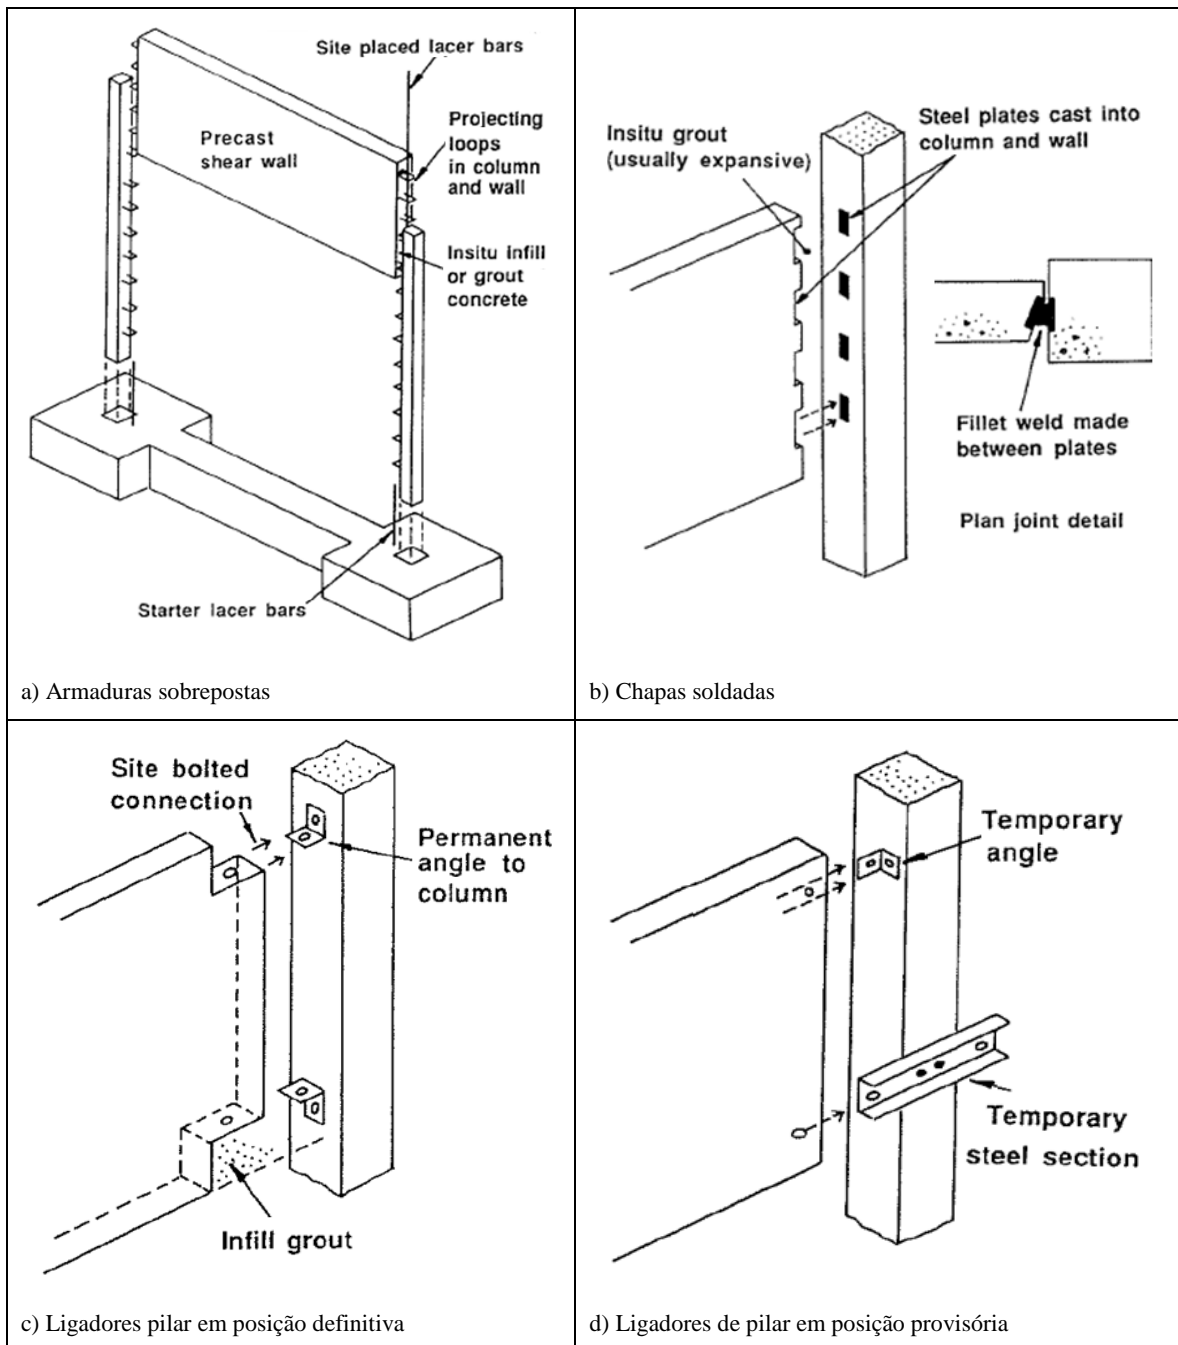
Ligações parede-estrutura (pilar e fundação) (Elliott, 1996)
